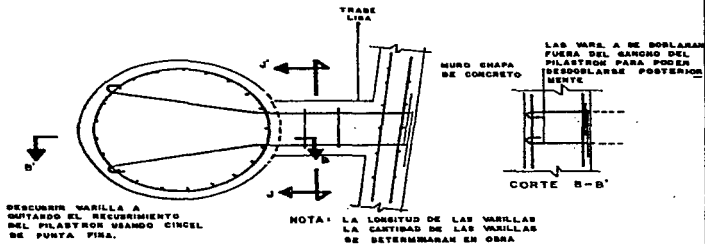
PLANTA DE SEMBRADO DE PILASTRONES EN ZONA DE TANQUE
